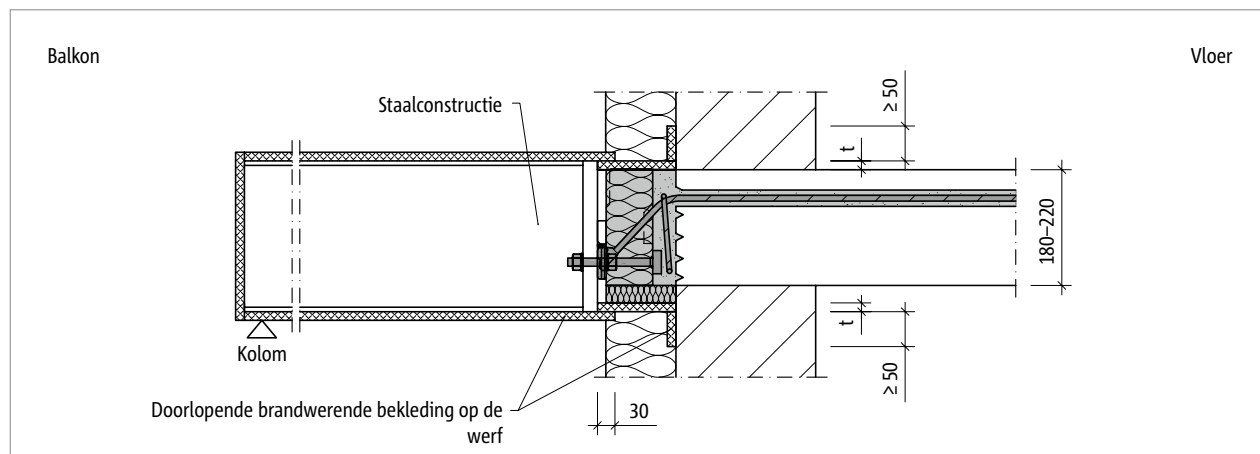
Schöck Isokorb® RT type SK: Op de werf aangebrachte brandwerende bekleding, RT type SK en staalconstructie; doorsnede
